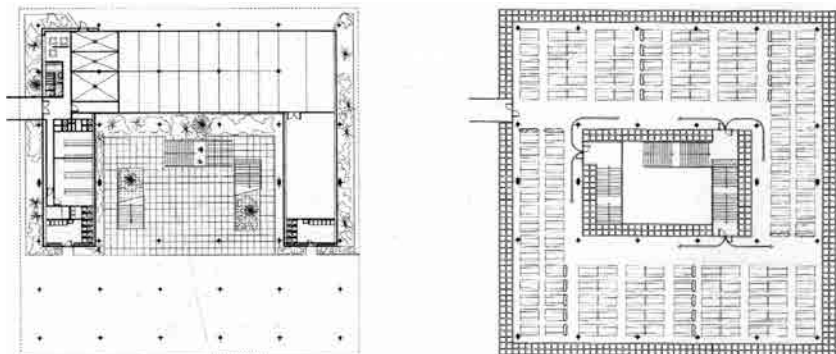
y Fig. 91 Comedores cuadrados. Planta baja (izquierda) y planta alta (derecha).
